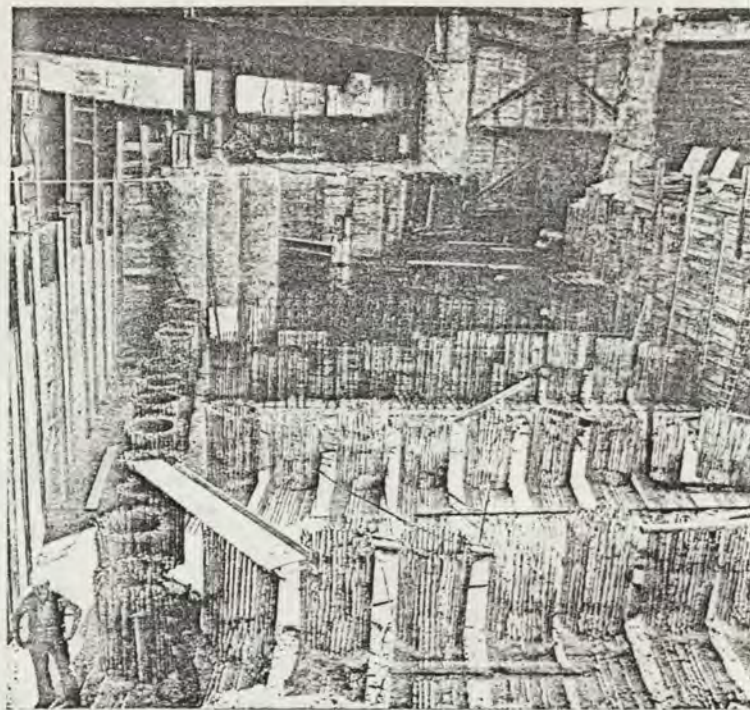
Blick auf die Pfahlköpfe des Widerlagers B vor dem Bewehren der Kopfbalken
